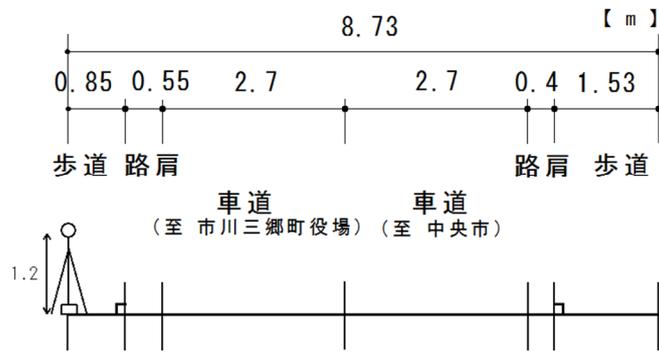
(4) 道路断面図 (RA4、RNV4)
